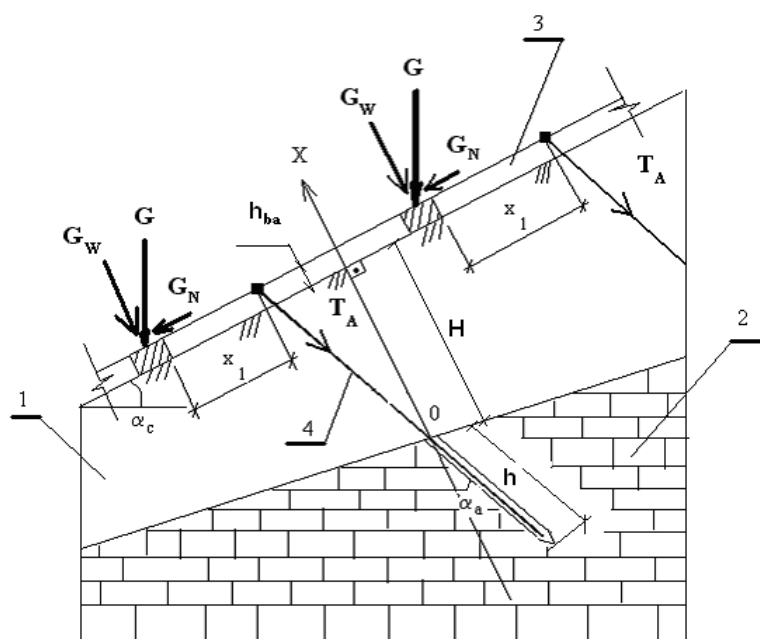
Расчетная схема перекрестно-балочного фундамента с предварительно напряженными анкерами
